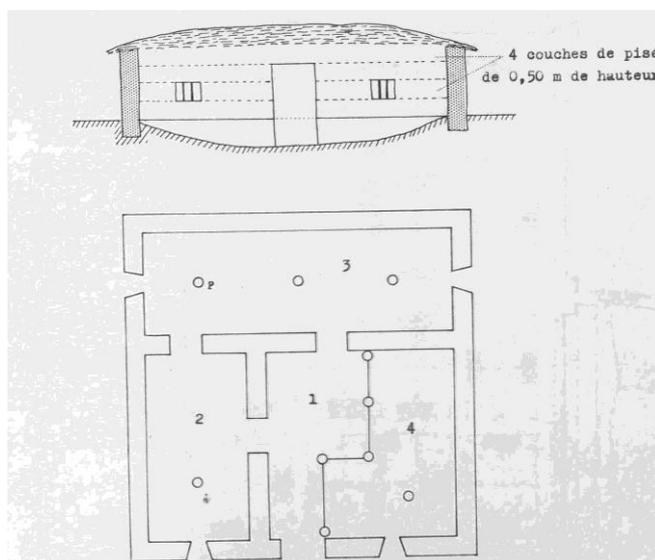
Plan et coupe d'une maison type du village du Capitaine Ferdinand Lapasset à Ténès.
